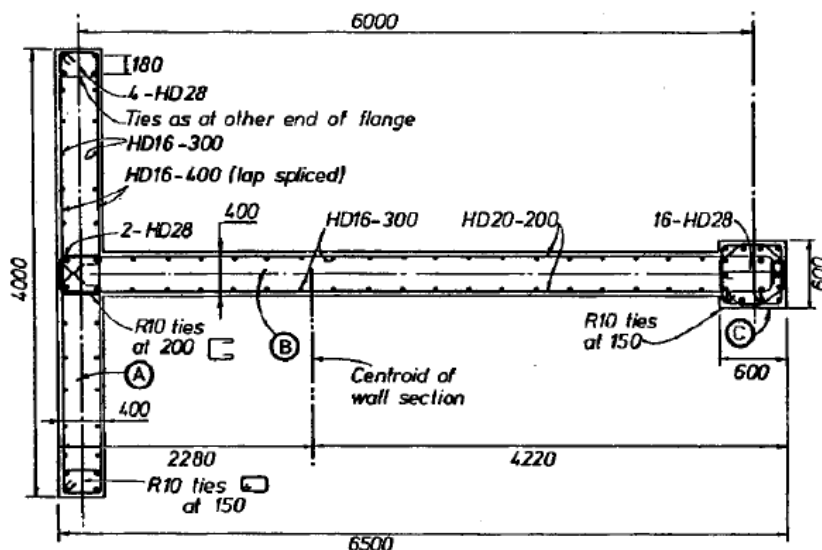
Ejemplo de Elementos de un Muro tipo T.
